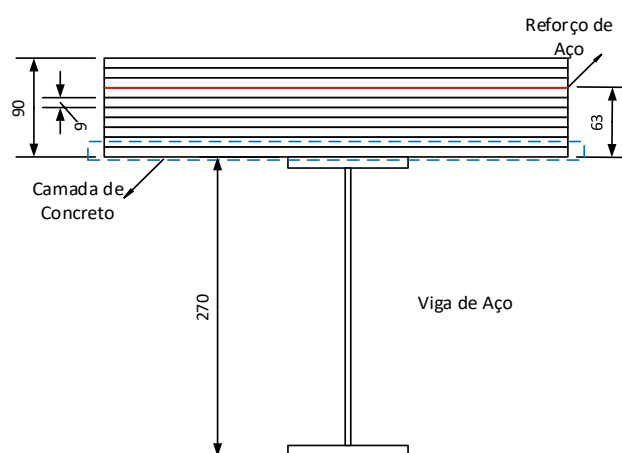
Esquema de camadas para a laje de concreto (Unidades: mm)
